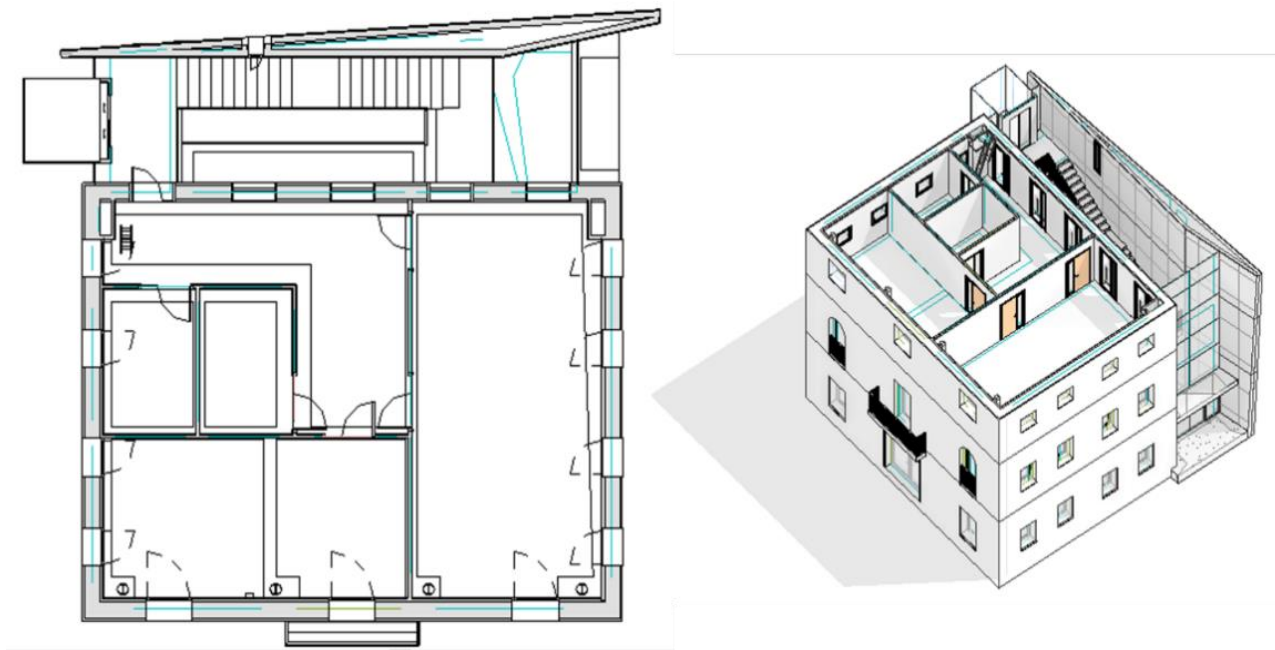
Planta 2º- Edificio de la sede UOC en el Baix Llobregat
